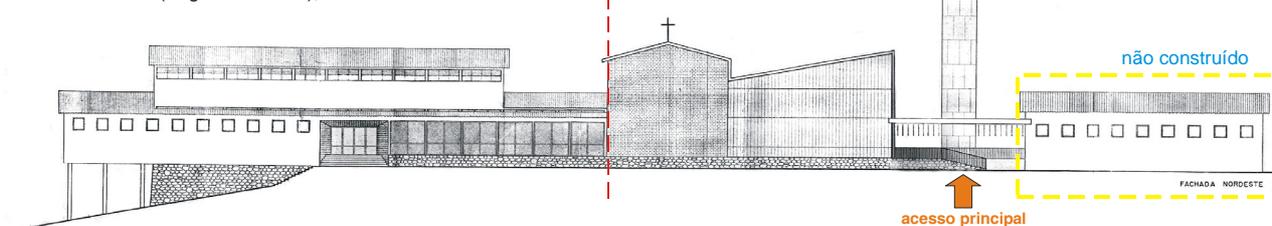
e 90: Fachadas Frontais – Primeira e Segunda Versões. (Desenho da autora, sobre plantas cedidas pelo Mosteiro).
